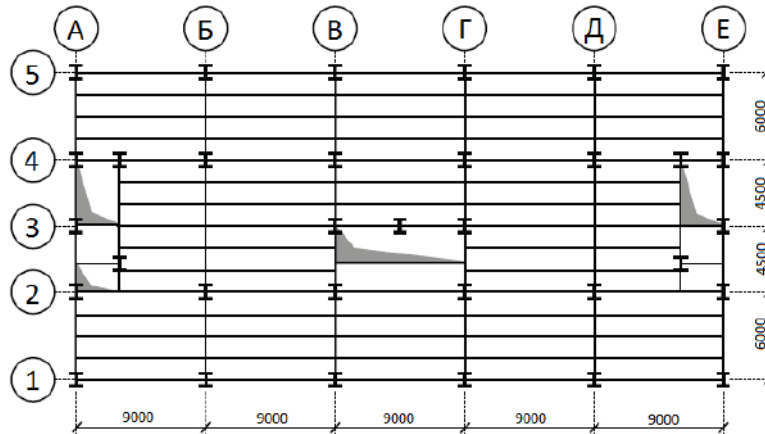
План здания для примера определения глобальных несовершенств перекоса
